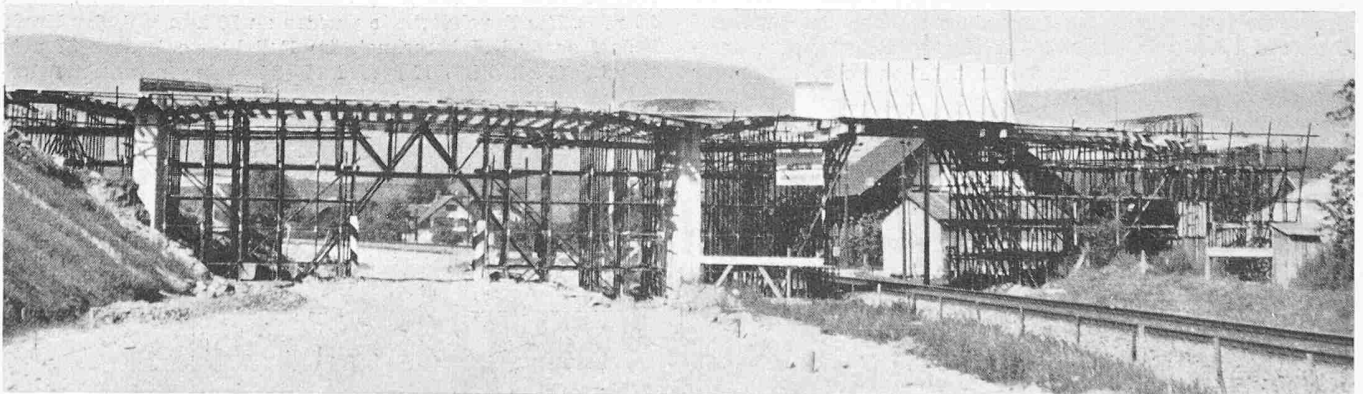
Lehrgerüst für Eisenbahn- und Strassenüberführung Studen-Biel
